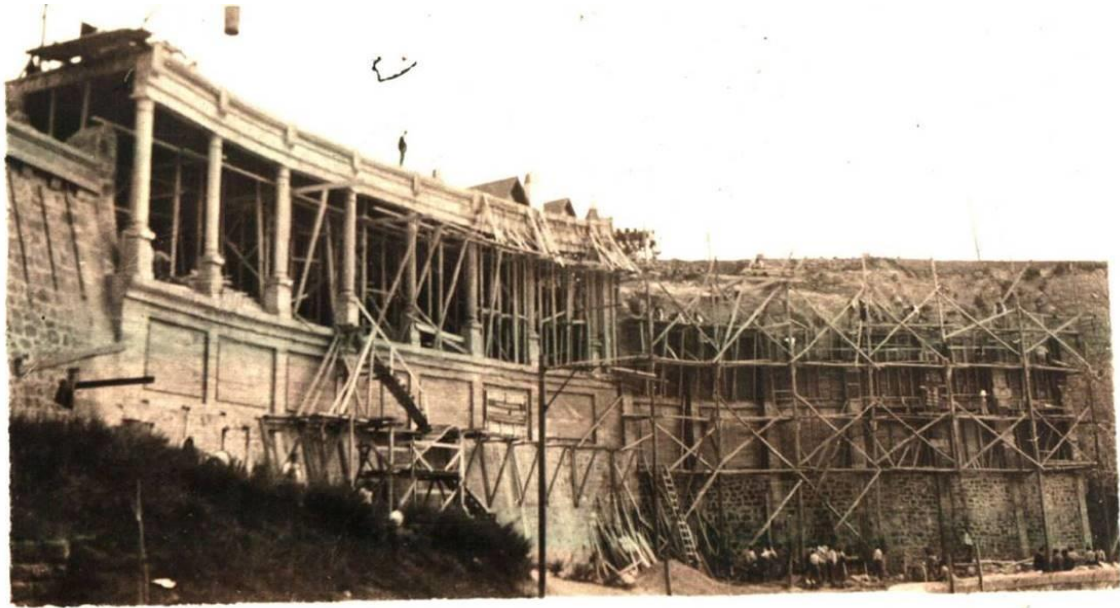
Construcción de las galerías en la zona del salón y arranque de la galería noroeste (1918-1923). Proporcionado por GPAC.
